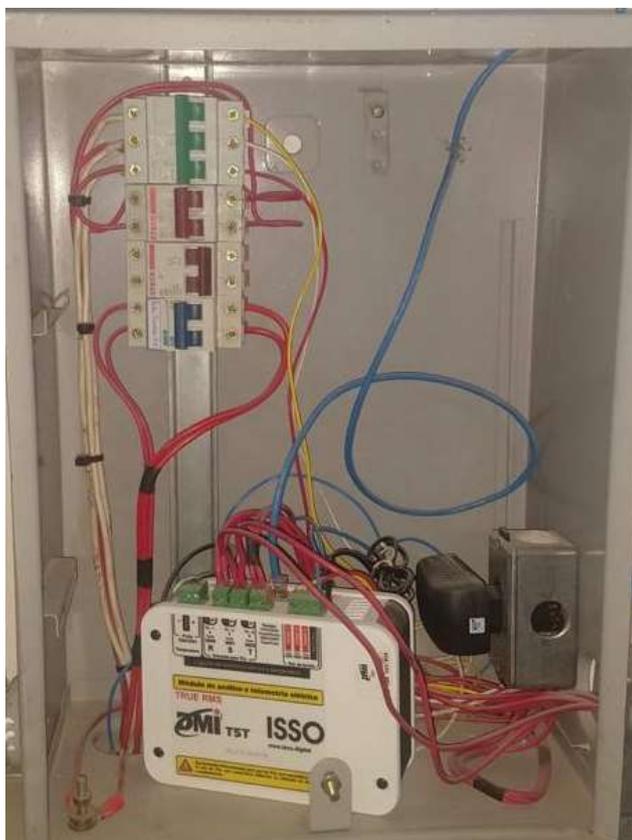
MEDIDOR ISSO T5T na caixa de medição
